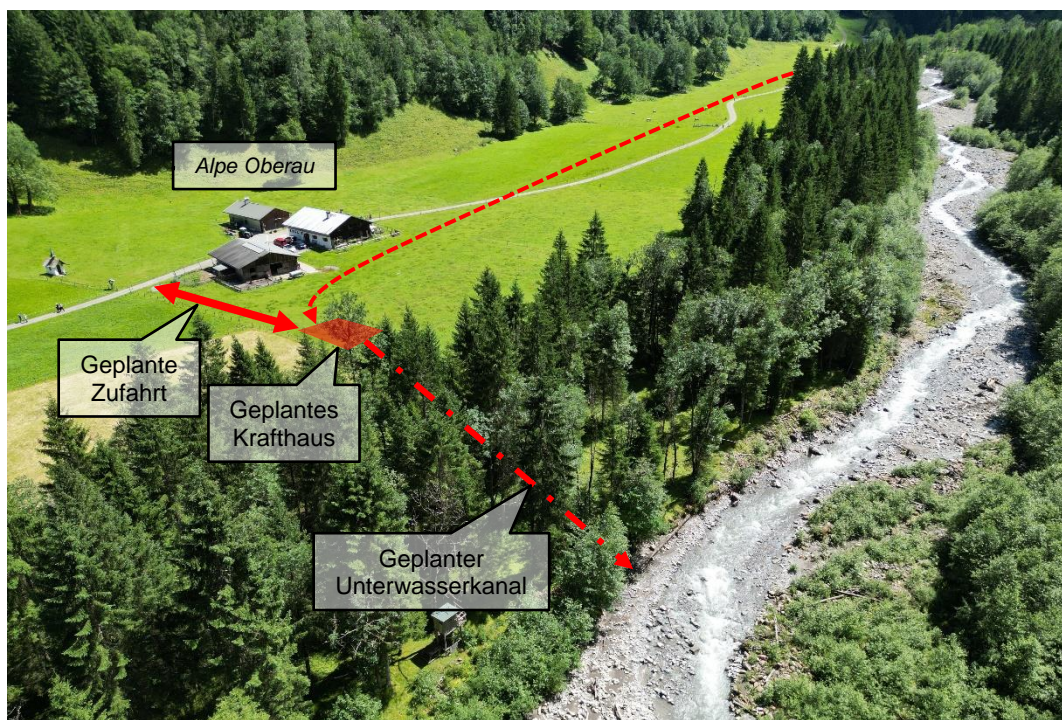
Geplanter Krafthausstandort mit Zufahrt und Unterwasserkanal (ITS Scheiber ZT GmbH, 2023)
